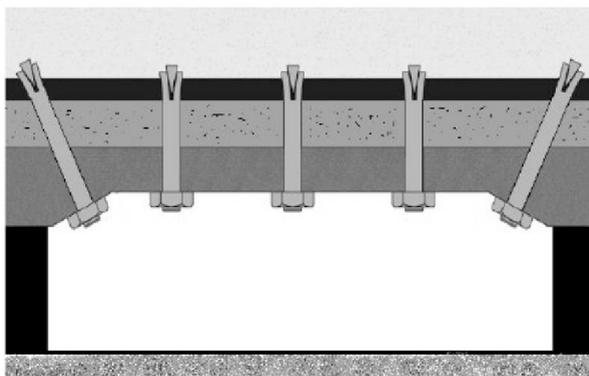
Схема «сшивания» анкерной крепью пород горных выработок
